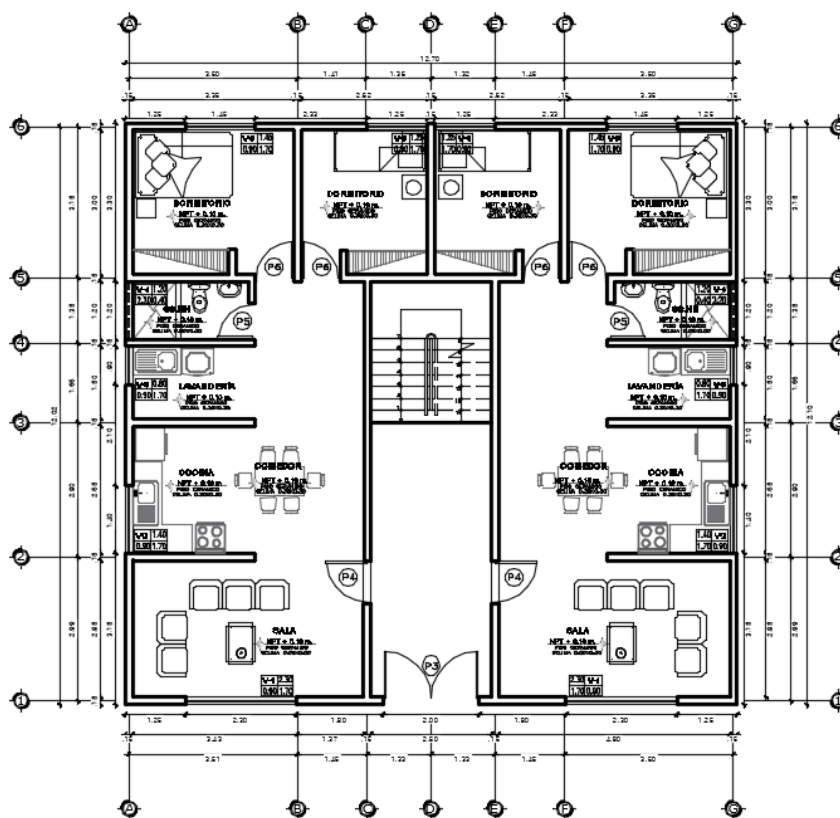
Distribución arquitectónica en planta del área techada del proyecto (Fuente: Elaboración propia).
